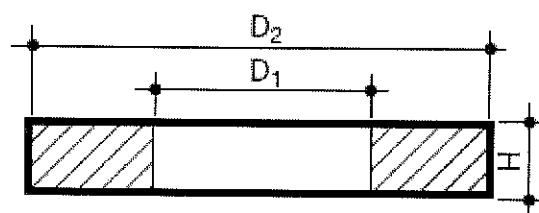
Pokrywa żeliwna z wypełnieniem betonowym
